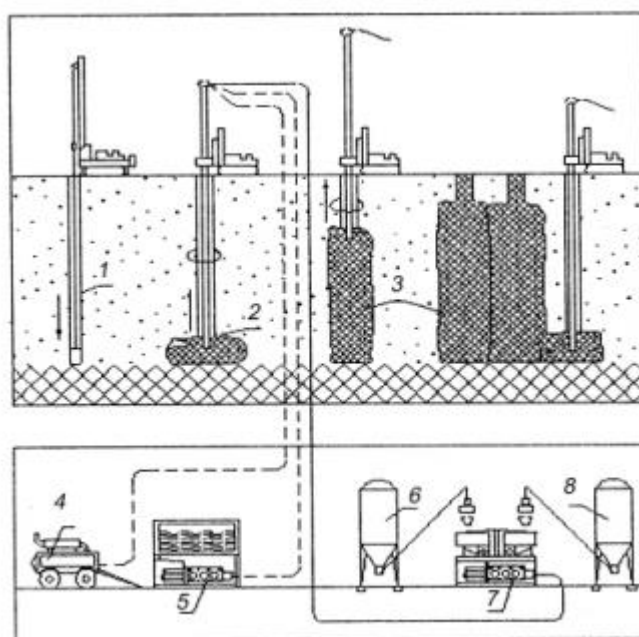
Схема устройства стенки из свай с использованием струйной технологии (jet grouting): 1 – буровая скважина до плотных грунтов; 2 – инъектор; 3 – формируемая свая; 4– компрессор; 5 – насос для подачи воды; 6 –емкостицемента и песка; 7 – растворонасос
